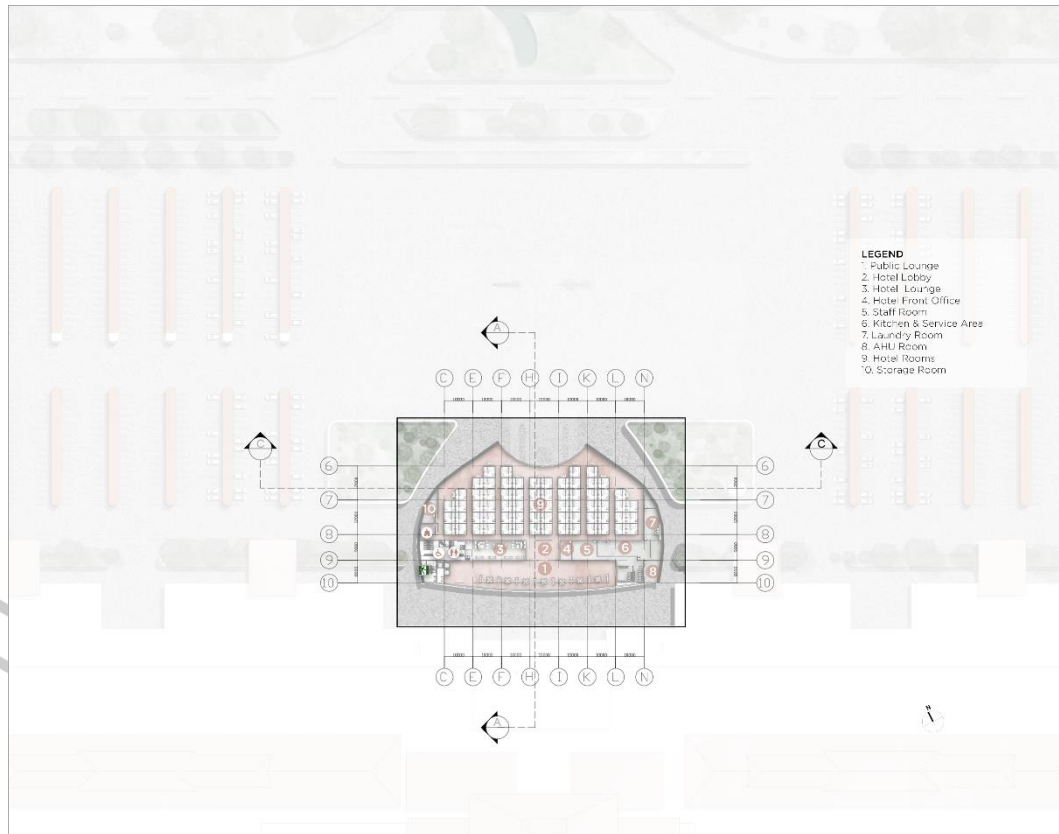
3 Denah Lantai 2 Juanda Intermodal Hub
